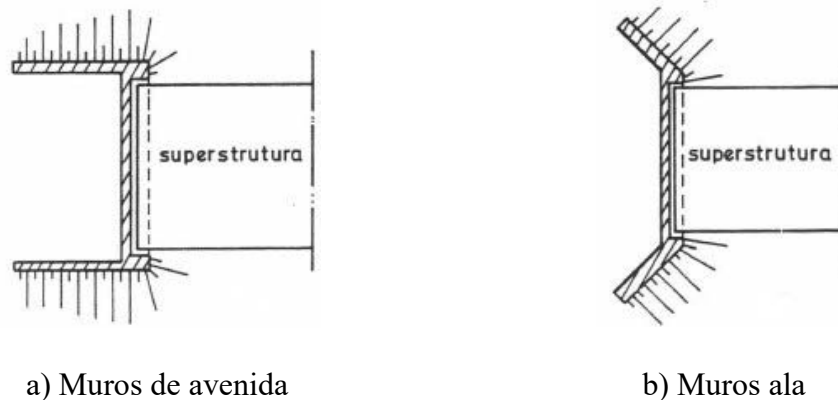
Encontros com muros de avenida ou muros ala, em planta (Reis, 1999).
